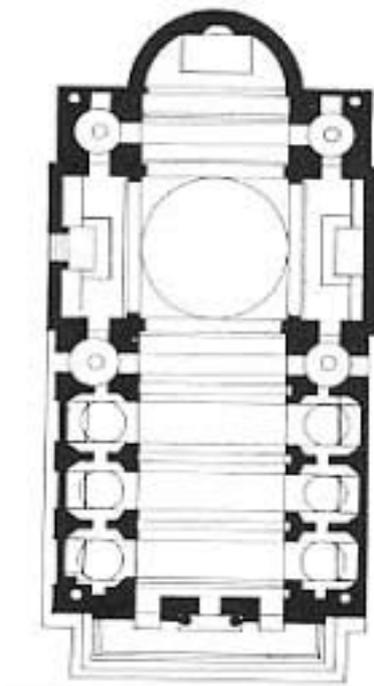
Planta de El Jesús (Fuente: Gympel)
